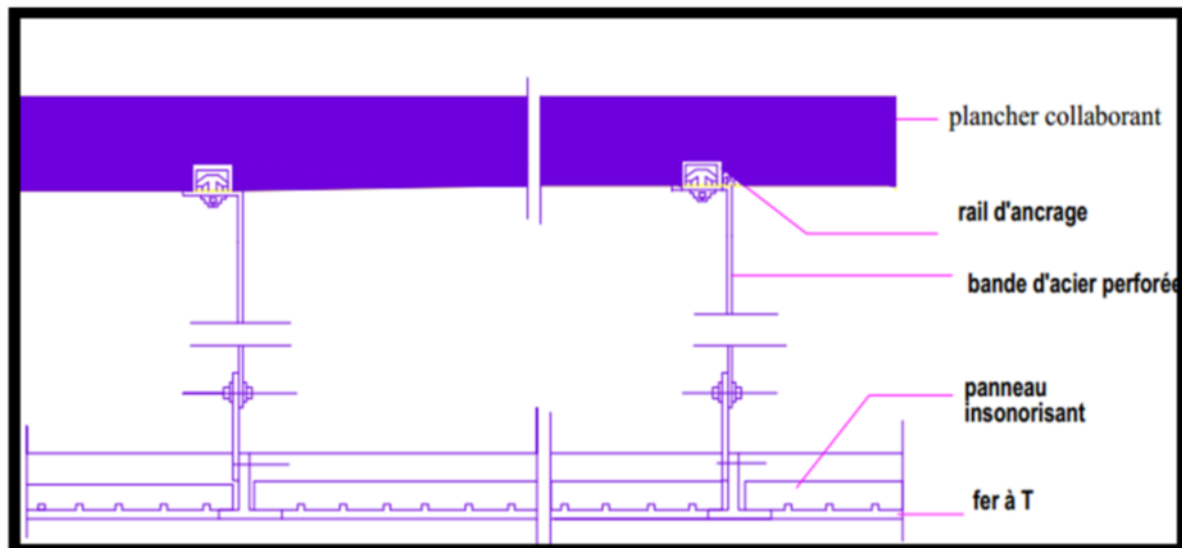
Détail d'assemblage entre un faux plafond et un plancher collaborant
